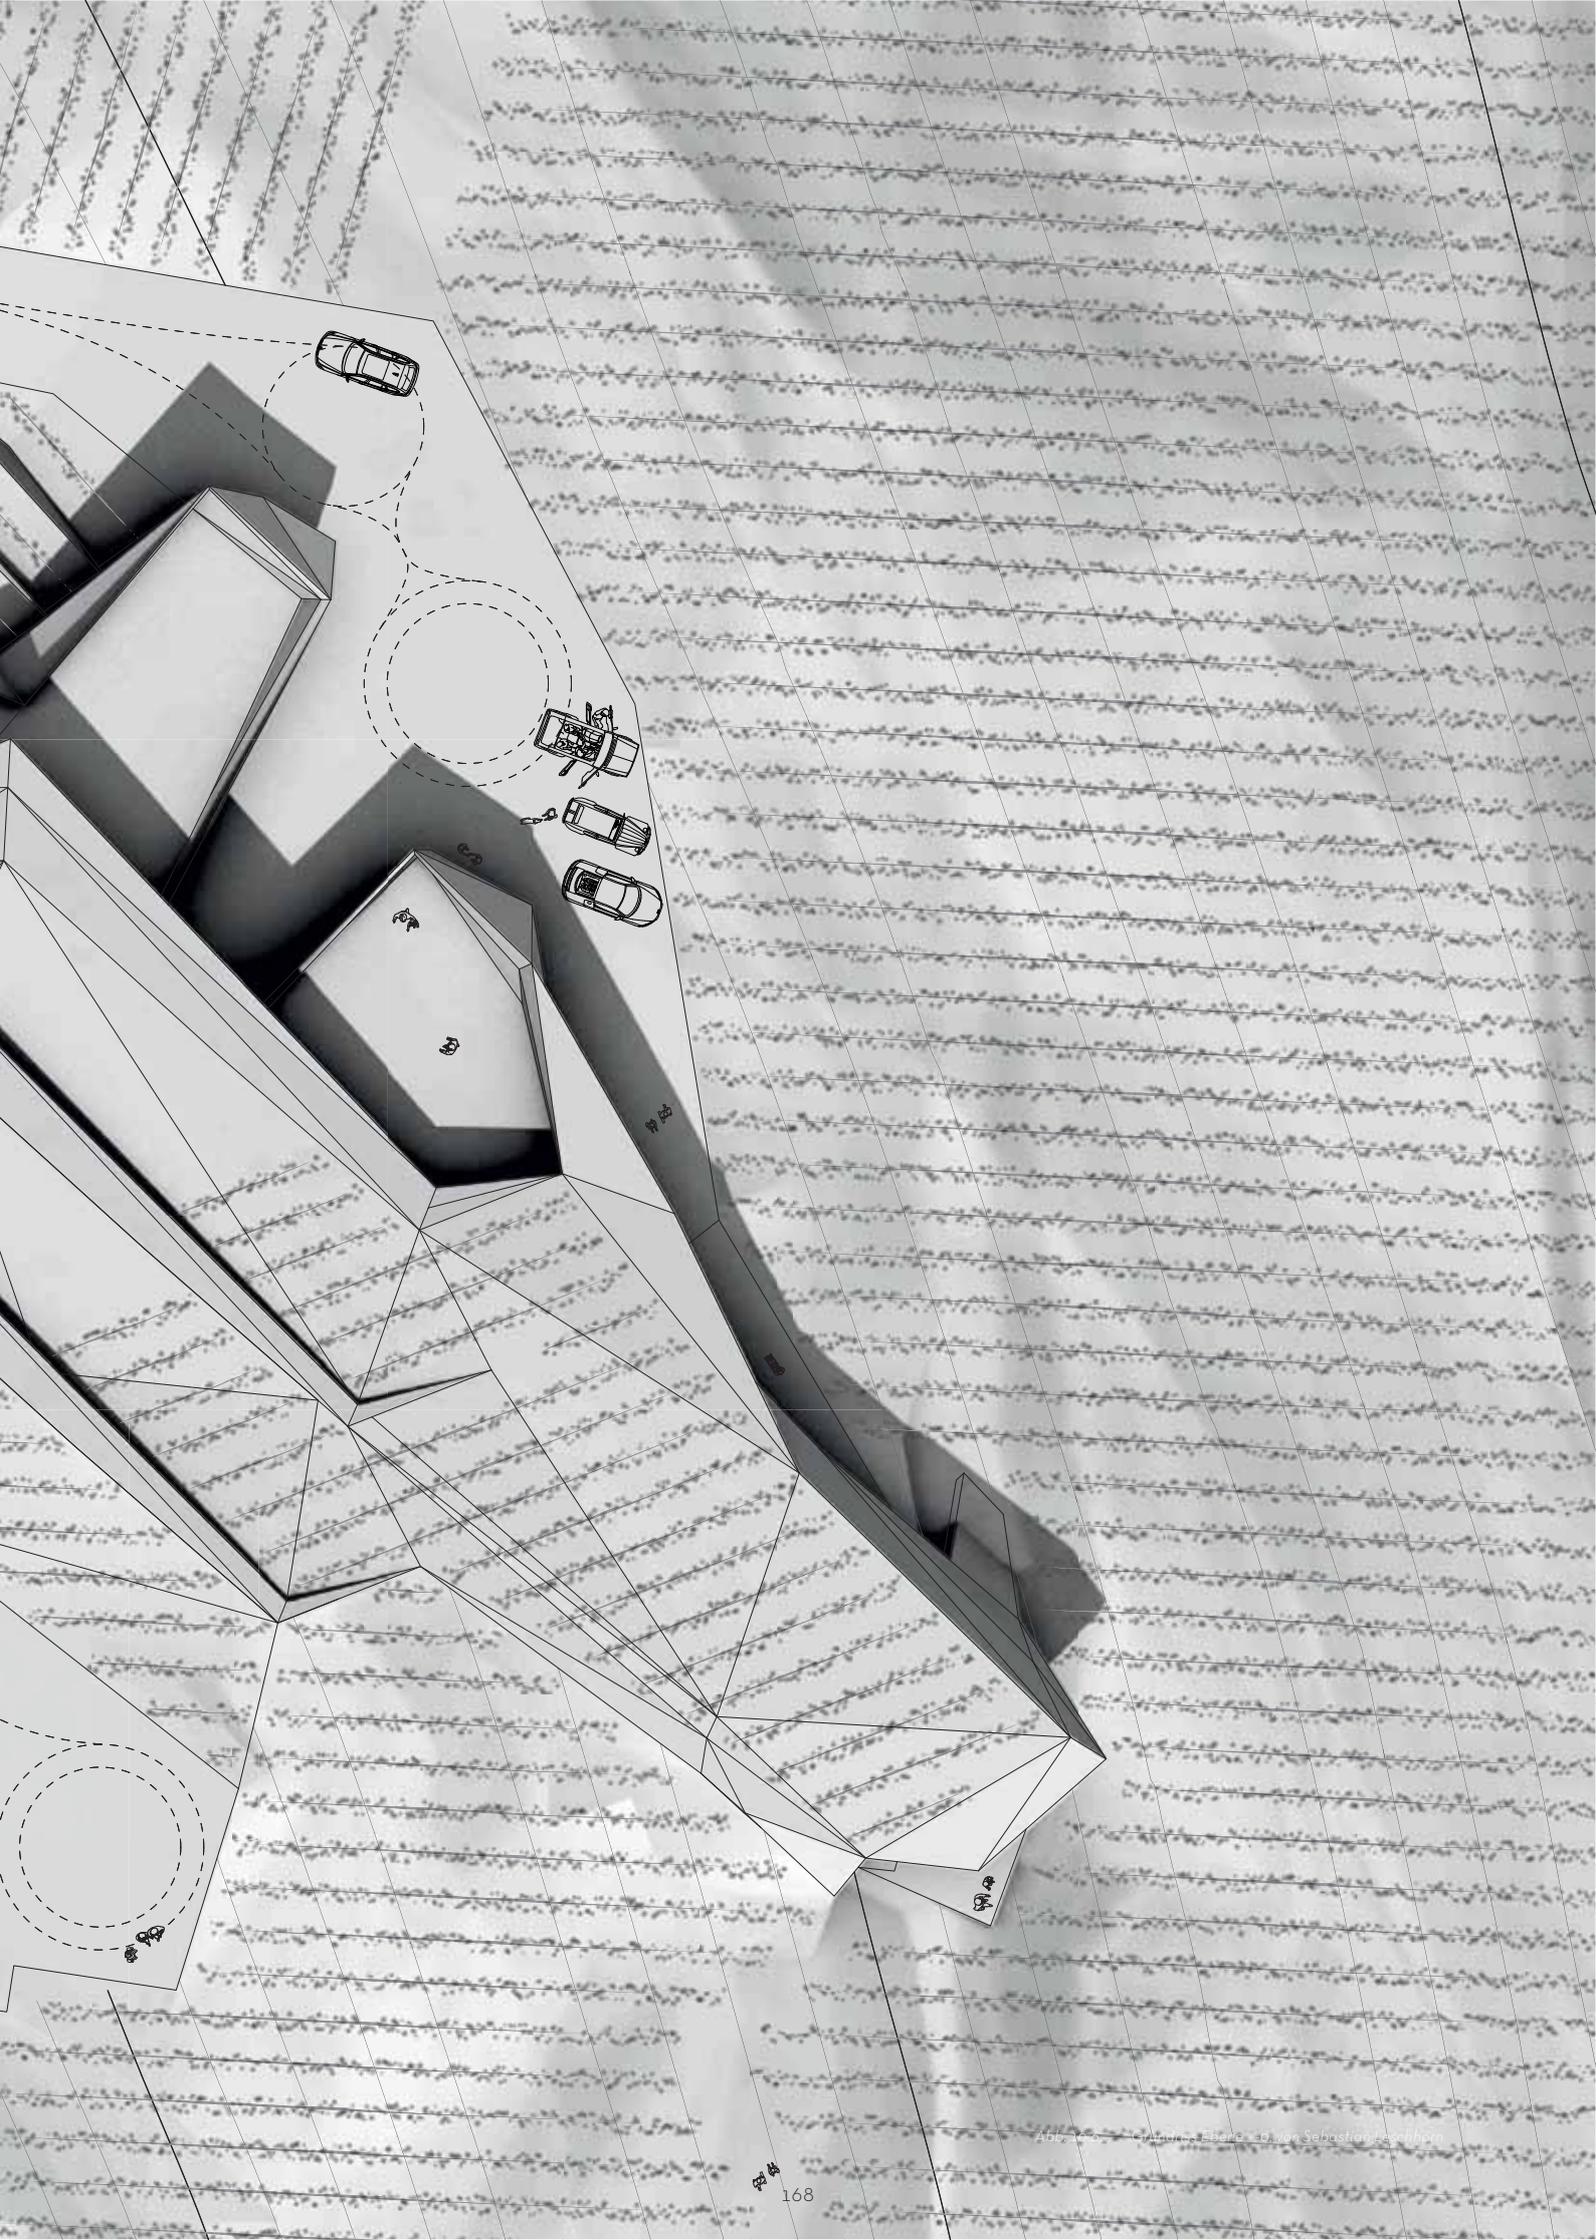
Grundriss Ebene 1a, von Sebastian Eschhorn
